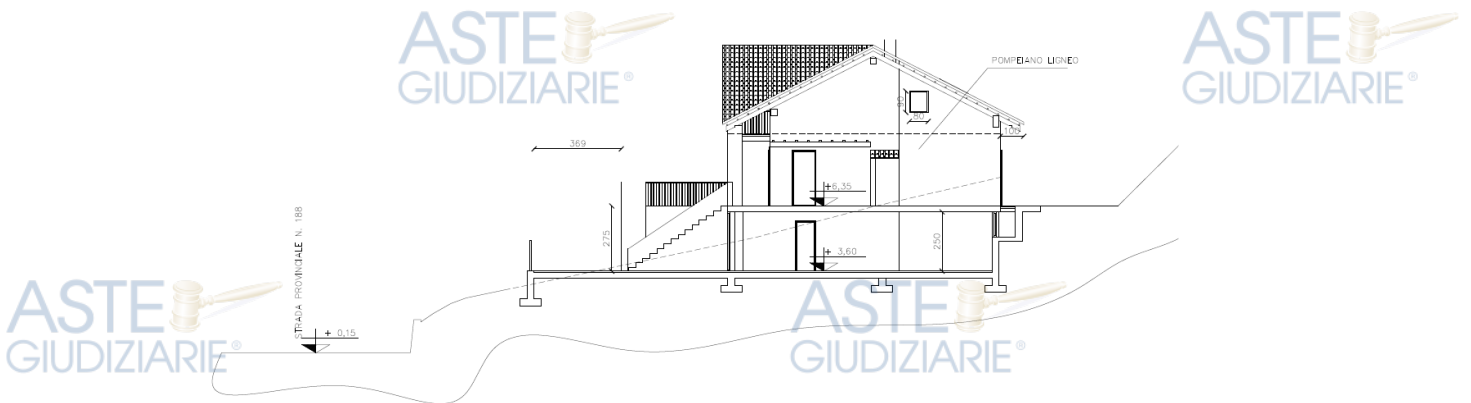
Sezione vista da sud-est dei due villini (estratto dalle tavole progettuali dell'arch. *)
